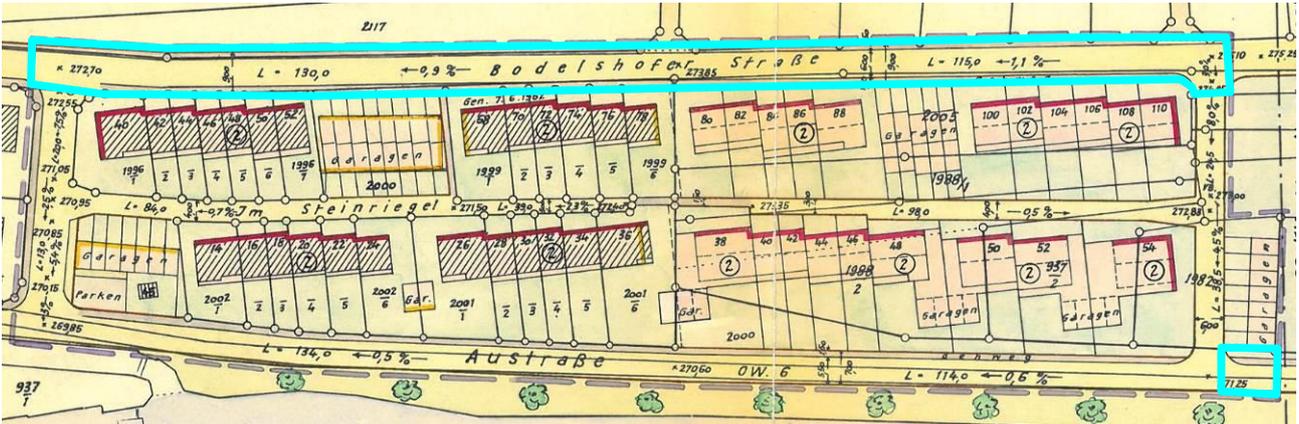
Ausschnitt aus dem Bebauungsplan Erweiterung „Au“ 1965, blau: Überschneidung mit dem Geltungsbereich des Bebauungsplans „Steinriegel 1 (BA 1a)“
